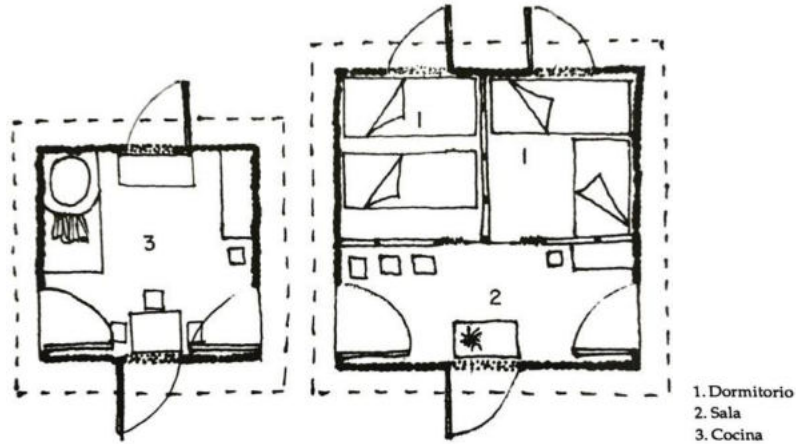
Planta de casa mejorada garífuna Fuente: (Salinas, 2002)
